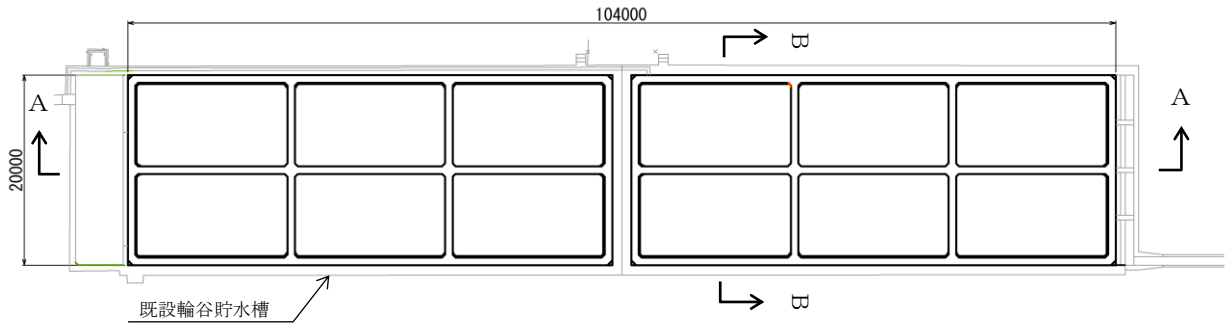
輪谷貯水槽（西側） 平面図 (単位: mm)
